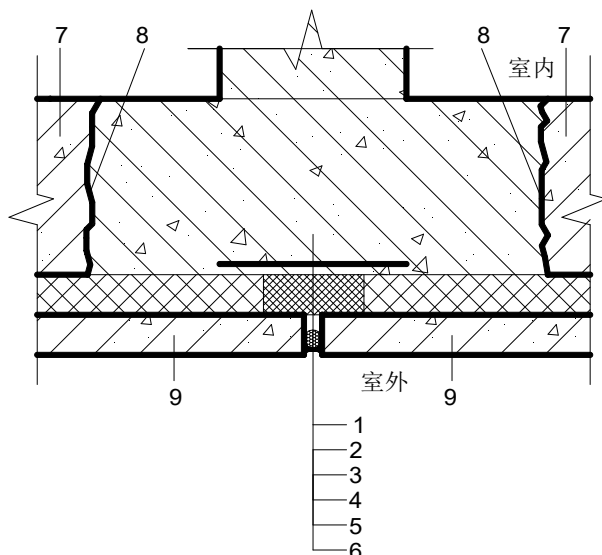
预制混凝土夹心保温墙板垂直缝密封防水构造
